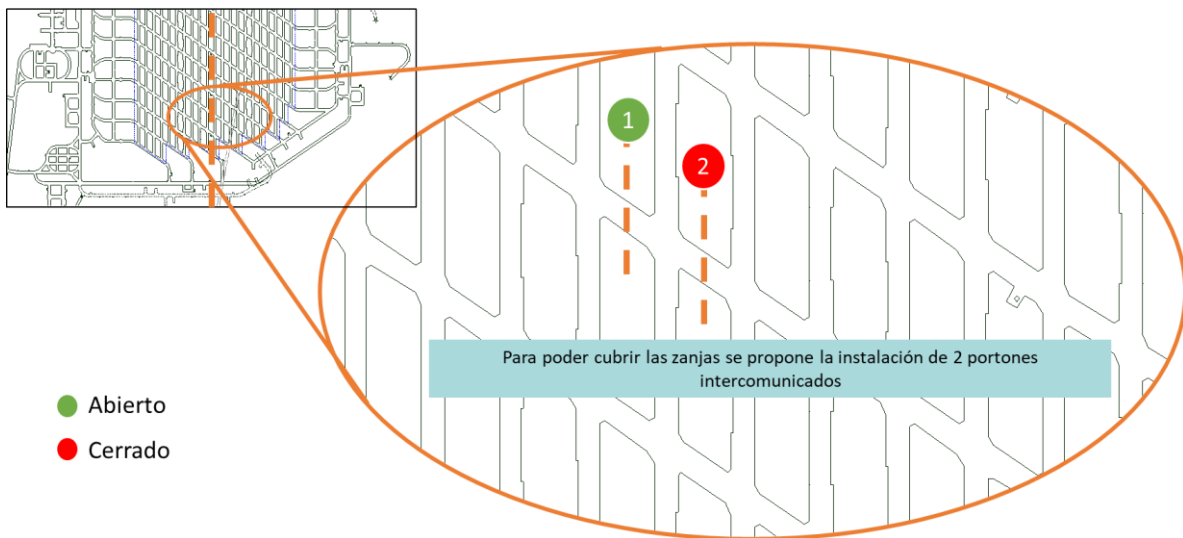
Configuración barreras en zona divisional de semi-calles
